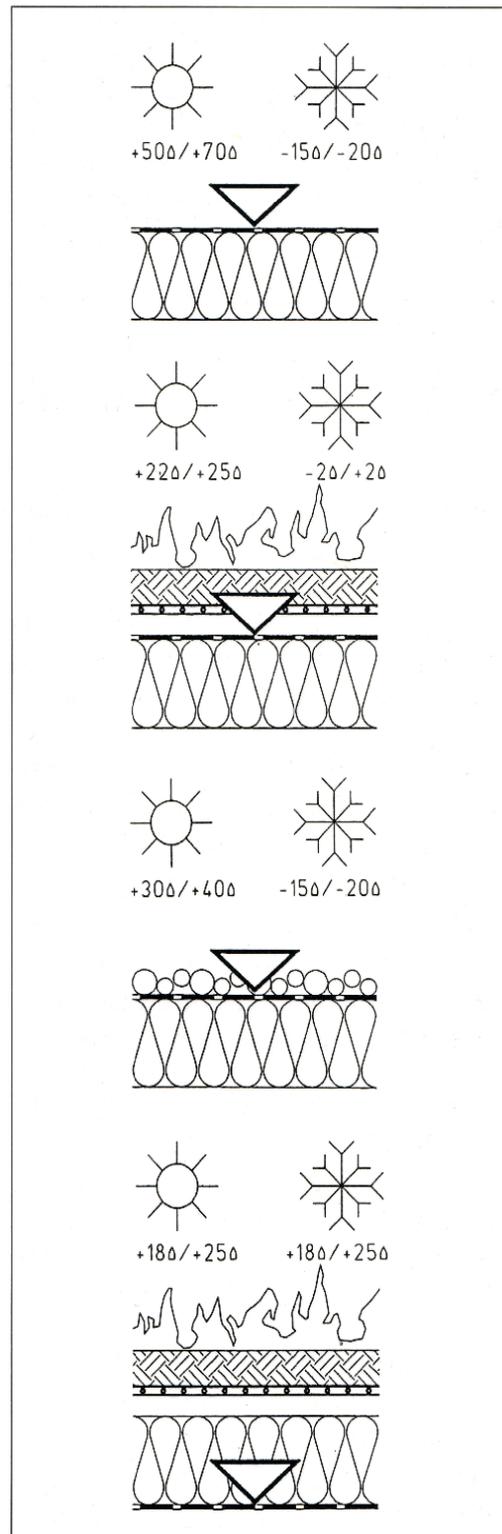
Einfluss Umgebung auf Dachkonstruktion, Quelle: Drefahl, Dachbegrünung Abdichtung; Dichtungsschutz; konstruktiver Aufbau, Köln 1995, S.21.
